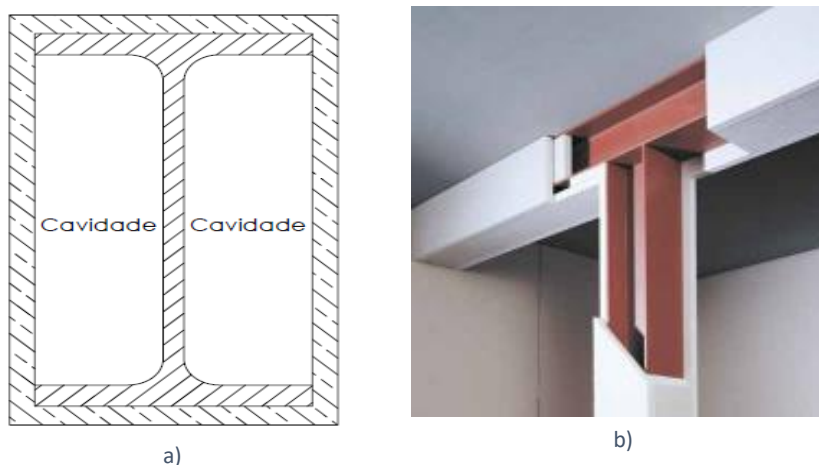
Proteção passiva de perfis em aço. a) Perfil protegido em caixão e b) Vigas e colunas protegidas com placas de gesso [48]
